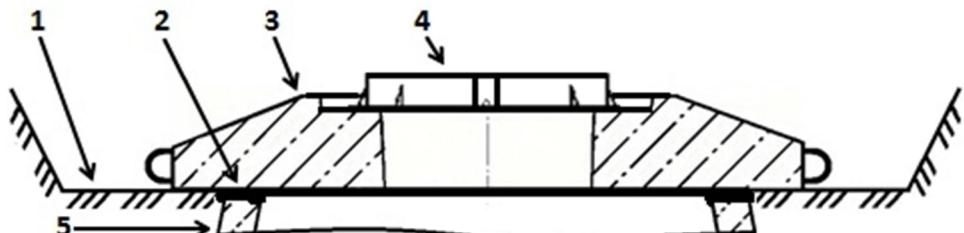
Плита ОП-1к-У установлена на колодец с удалённым перекрытием.
